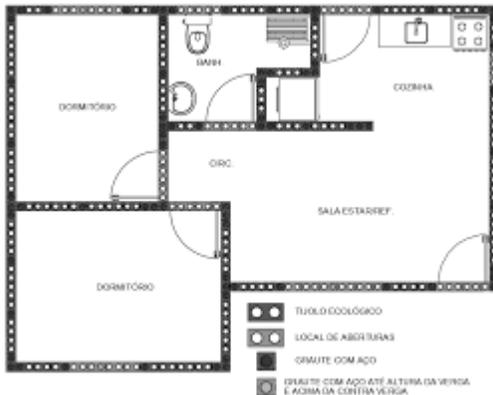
Uso de Tijolos de Solo Cimento na Modularização da Construção.
